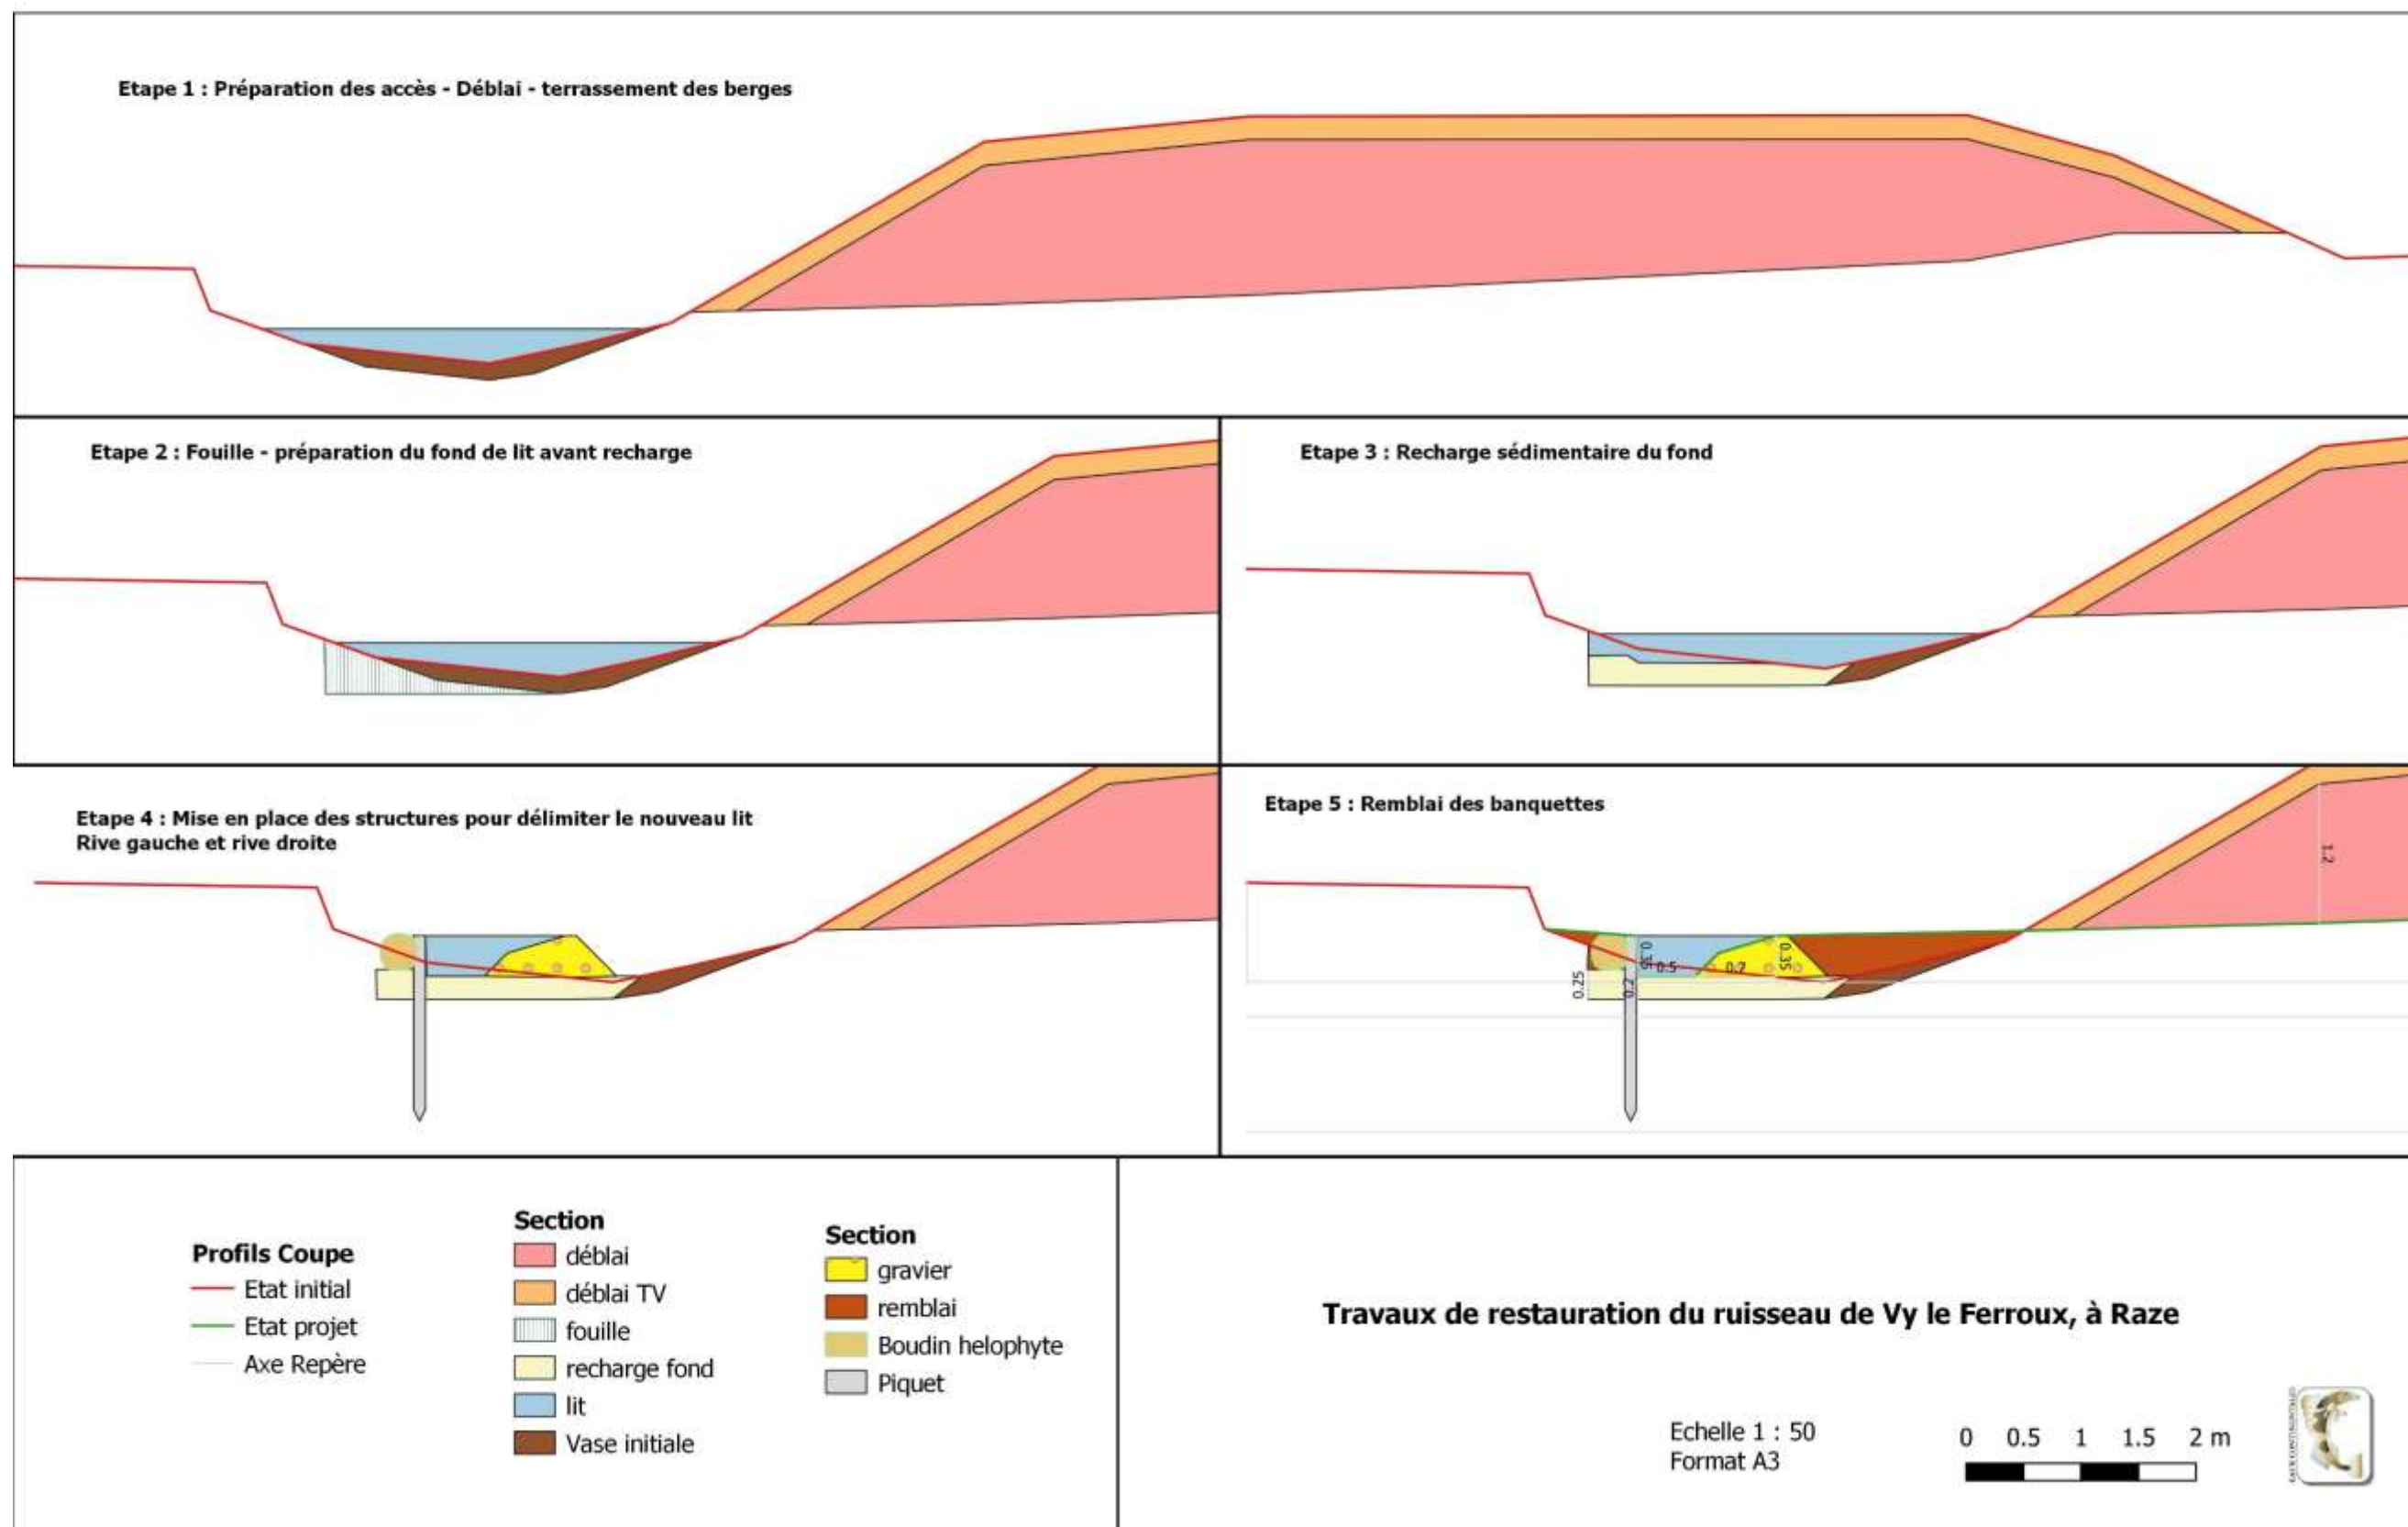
Etape de construction du nouveau lit – exemple du profil 30
